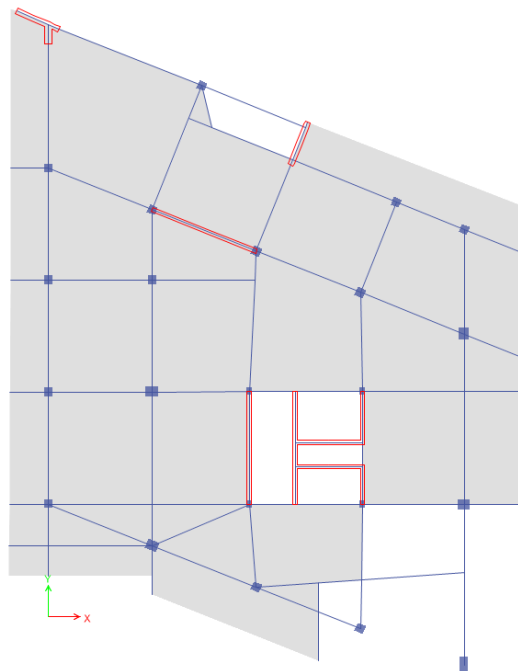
Distribución de elementos estructurales en planta (Losa Nivel 1)
